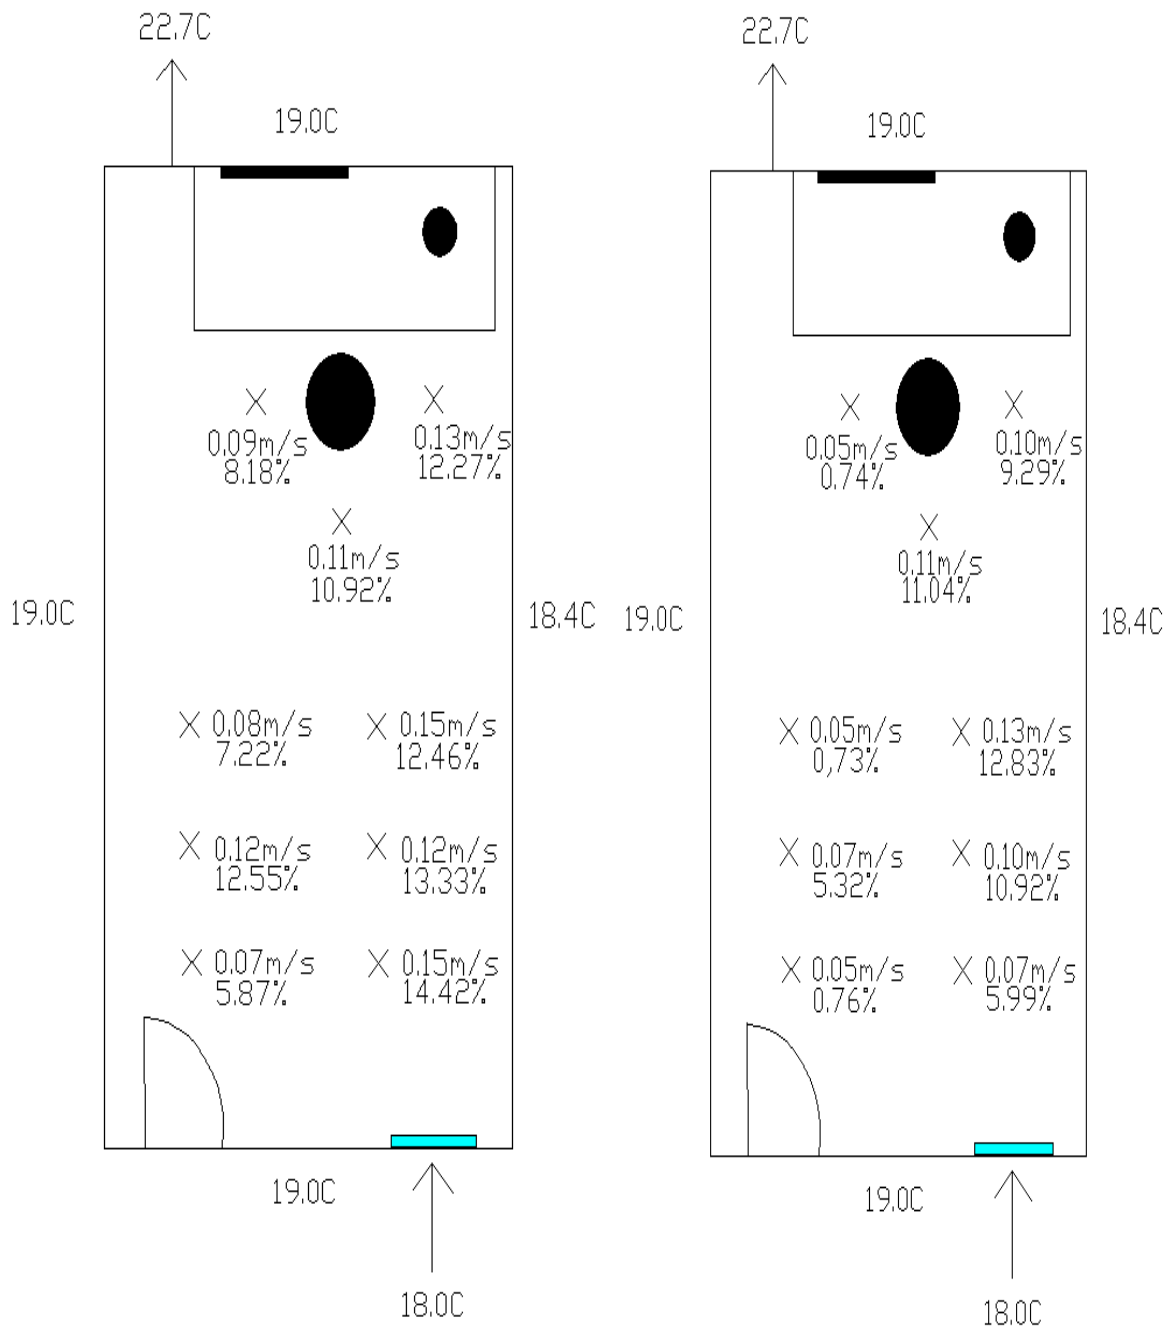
Til venstre: 5cm over gulvet. Til høyre: 10cm over gulvet.
